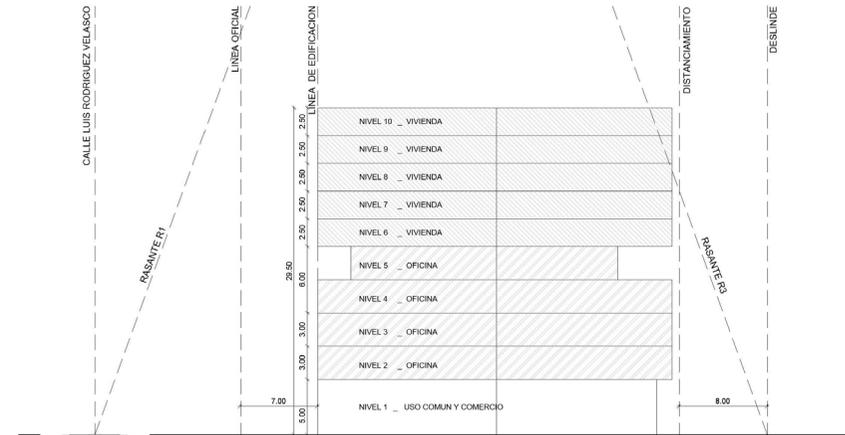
Plantas Tipo Cabida Uso Mixto.
